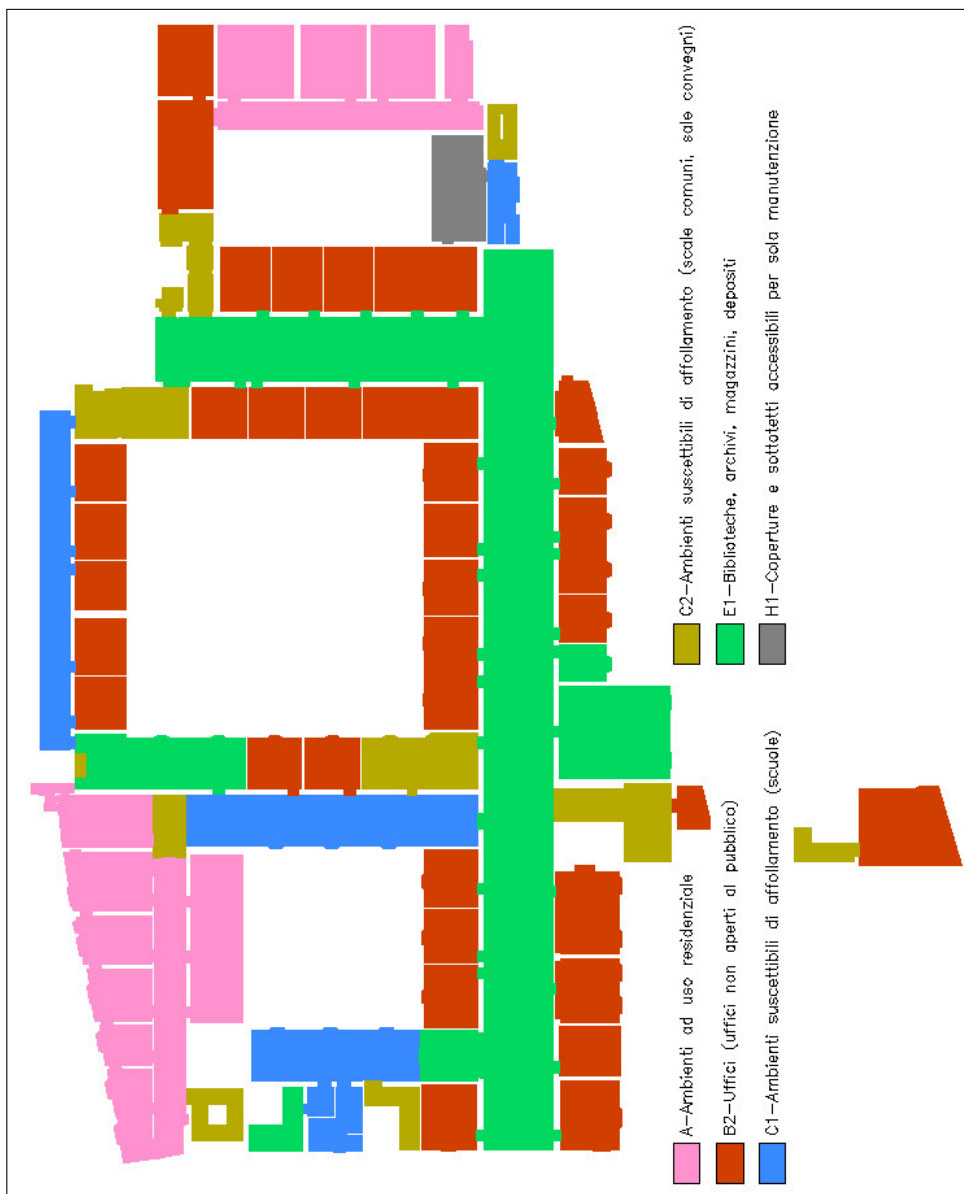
Pianta piano secondo. Carichi divisi per ambiente.
